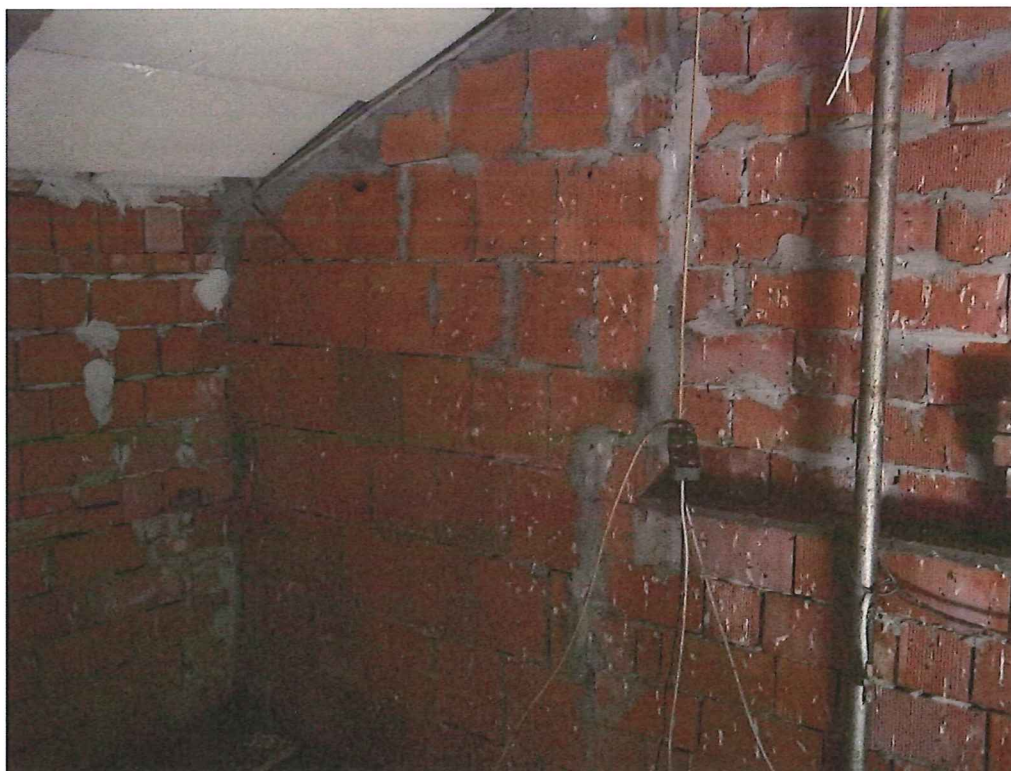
= Interno – Particolare delle diverse composizioni delle murature
